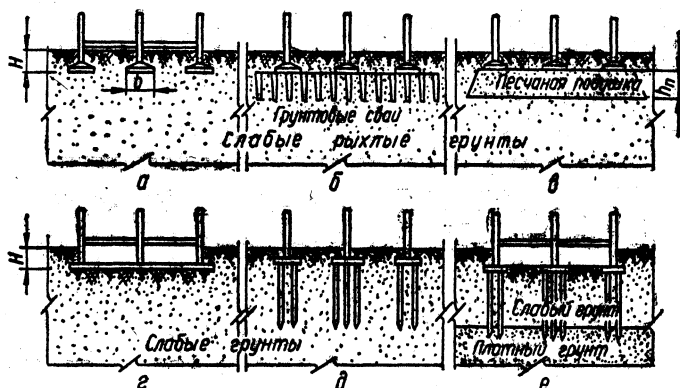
Типы фундаментов зданий с массивными стенами при слабых (рыхлых) грунтах:
